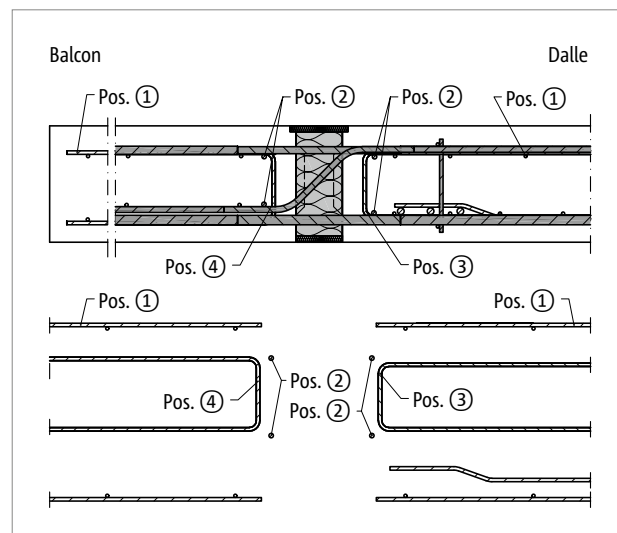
Schöck Isokorb® T types K-M13 à M14 : renforcement sur site pour support indirect
